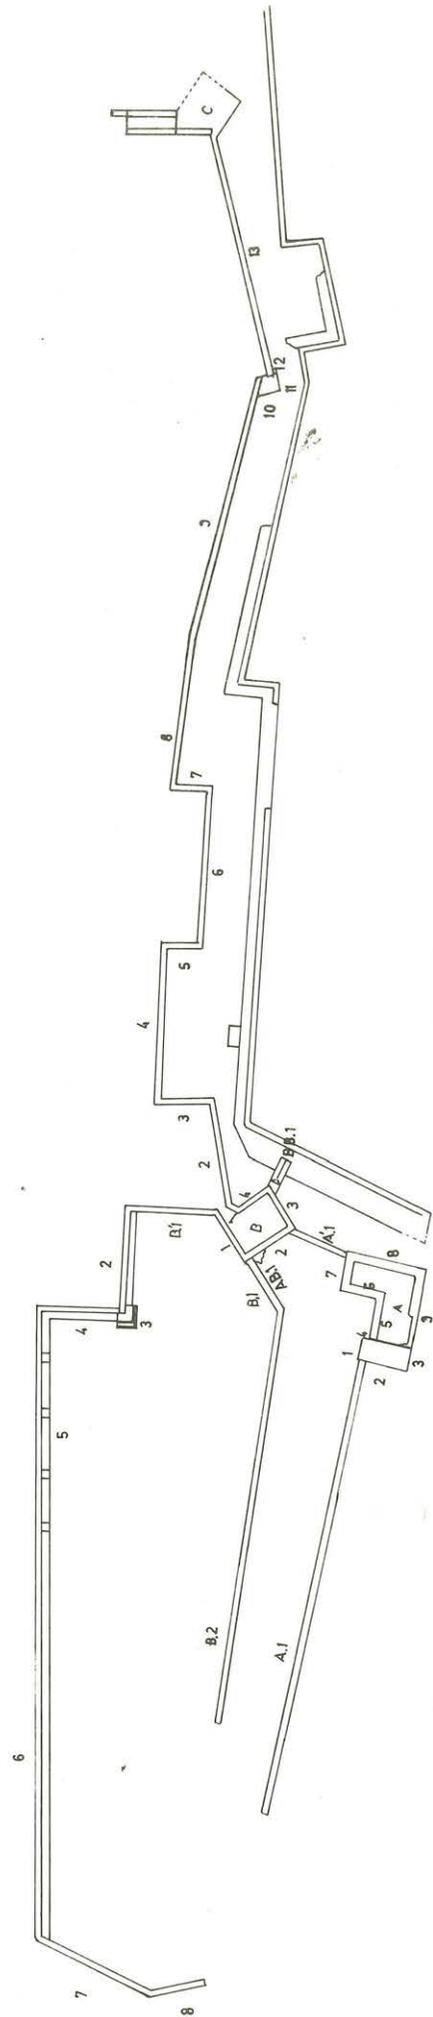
Planta del sector dibujado con nomenclatura de muros.
